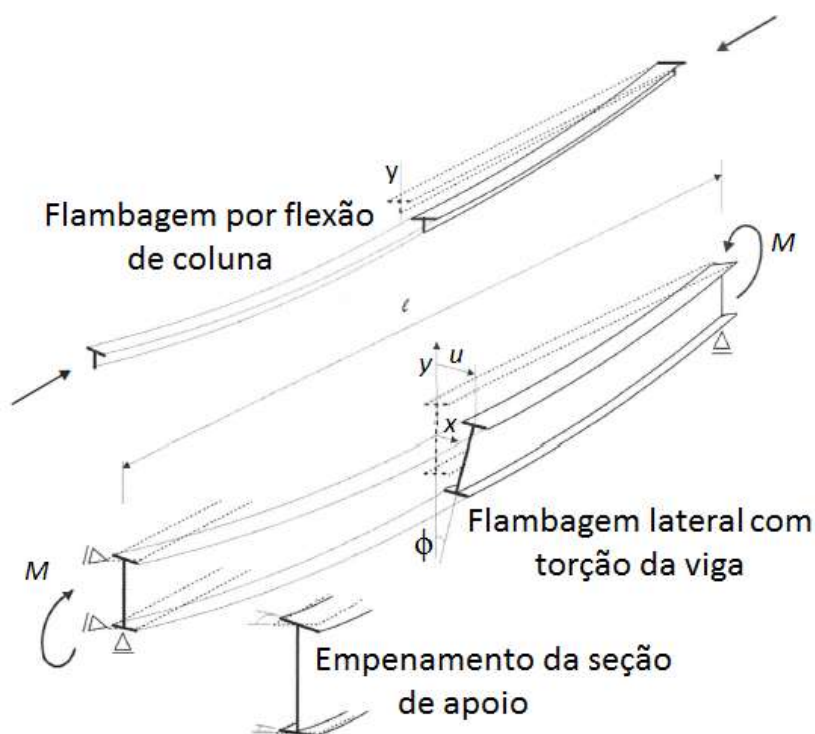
Flambagem lateral com torção da viga biapoiada
